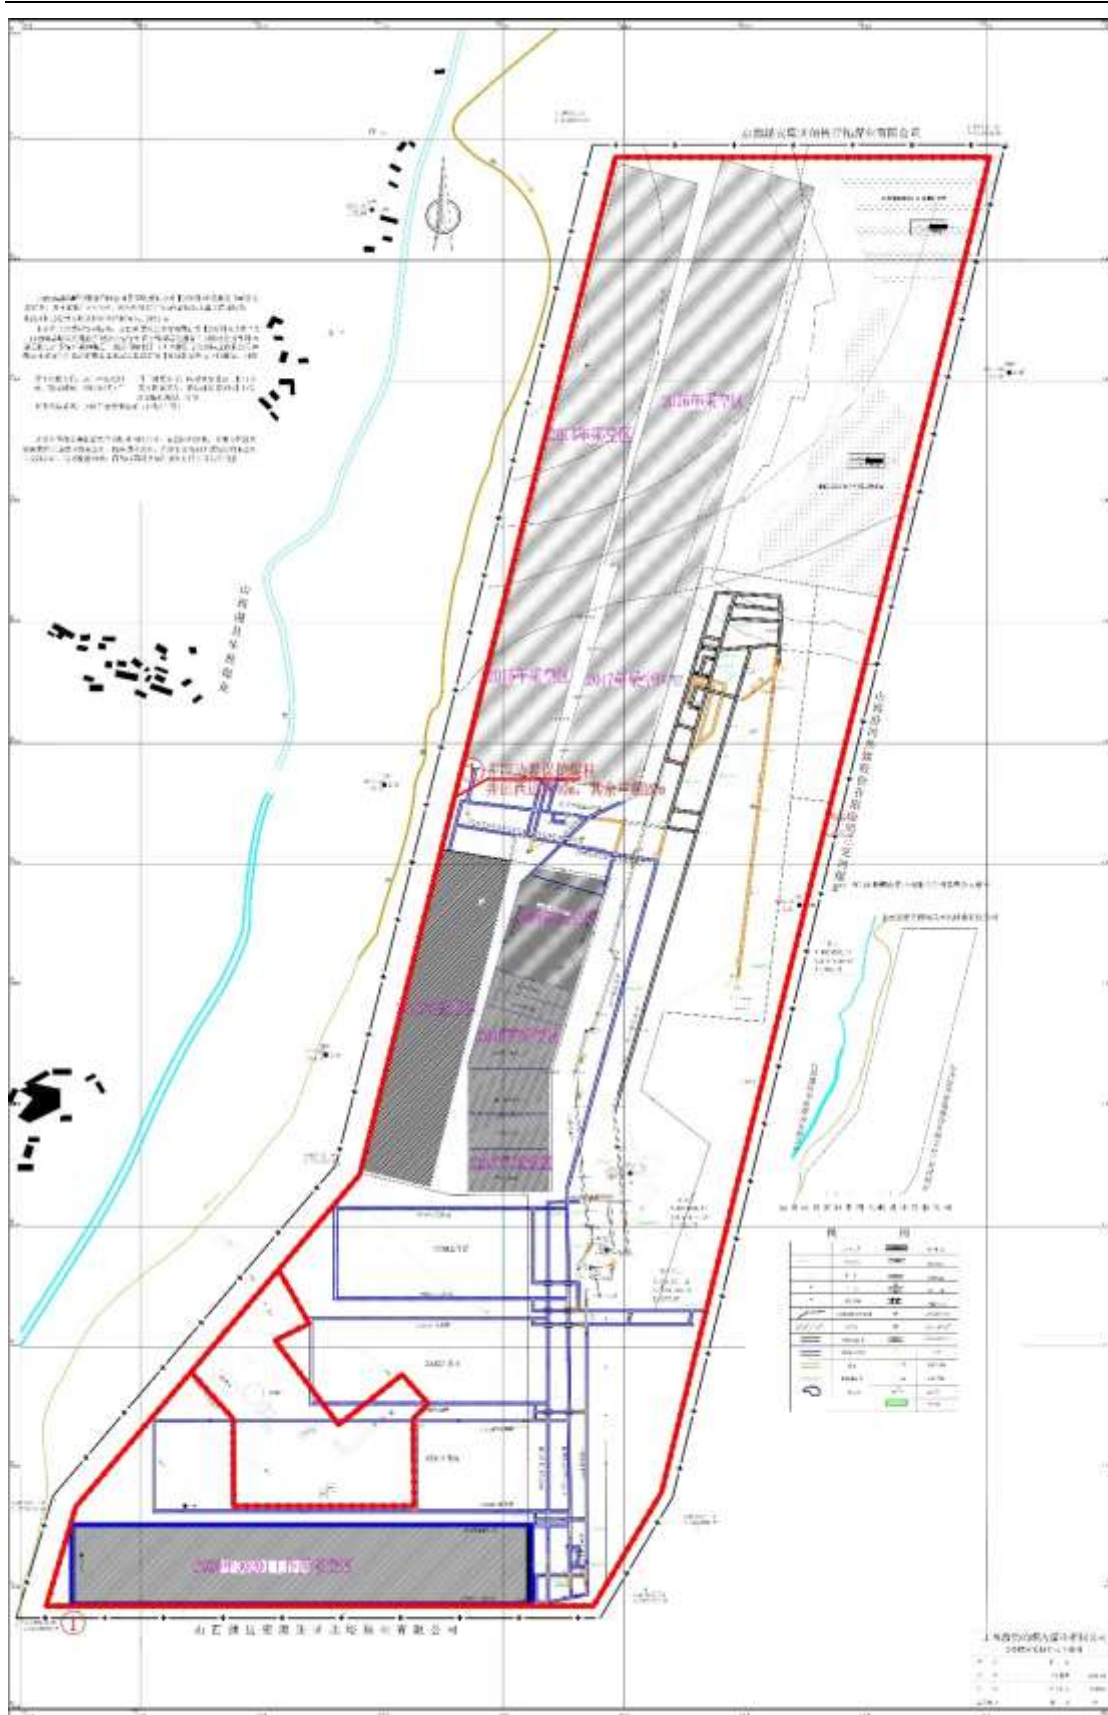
环评期间 3#煤采掘工程平面图
